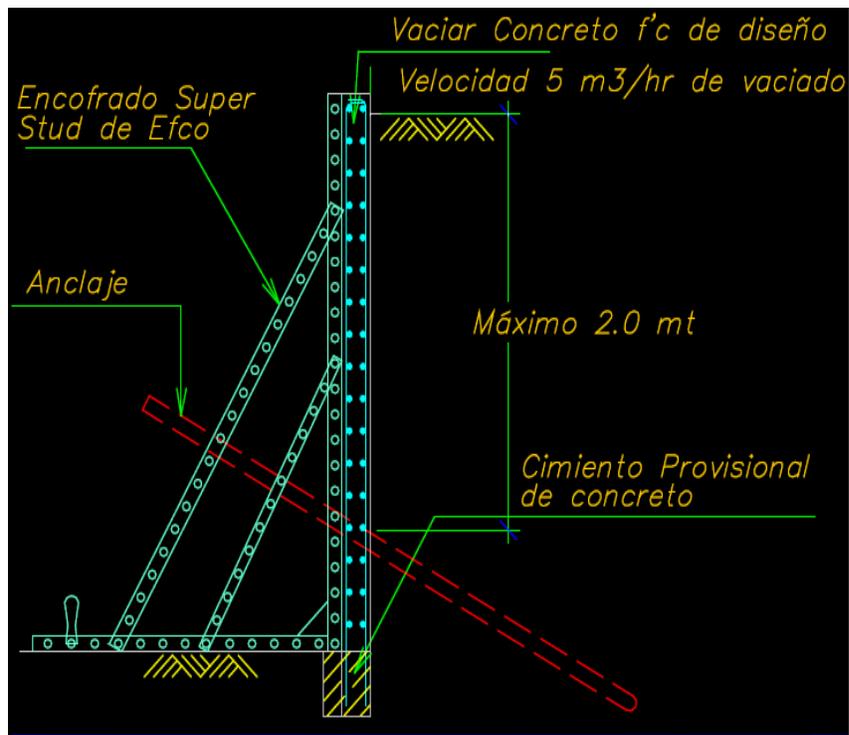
Paso 11°: Encofrado del paño del Muro Anclado
